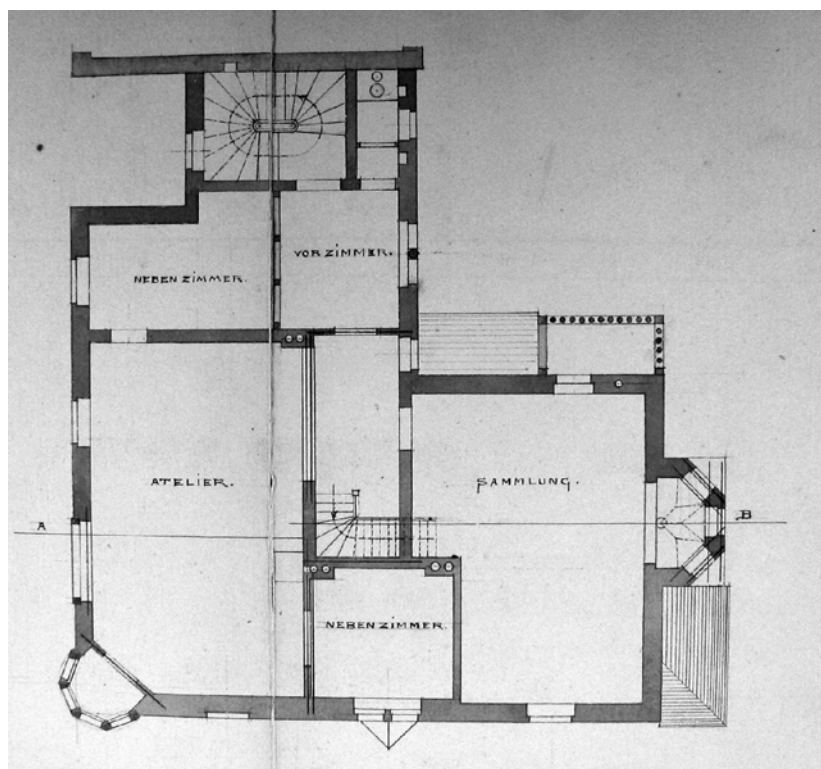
Grützner-Haus, Grundriß zweiter Stock, Leonhard Romeis, 1882, Plan nach Osten ausgerichtet.
